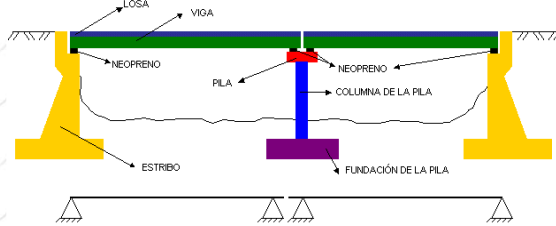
Puente de vigas isostático en varios tramo
